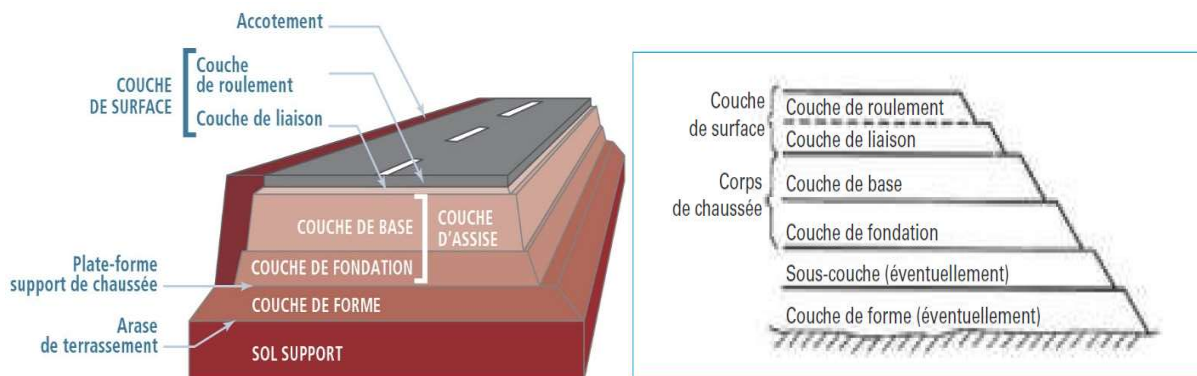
Vue en perspective et coupe transversale d'une chaussée [20].
